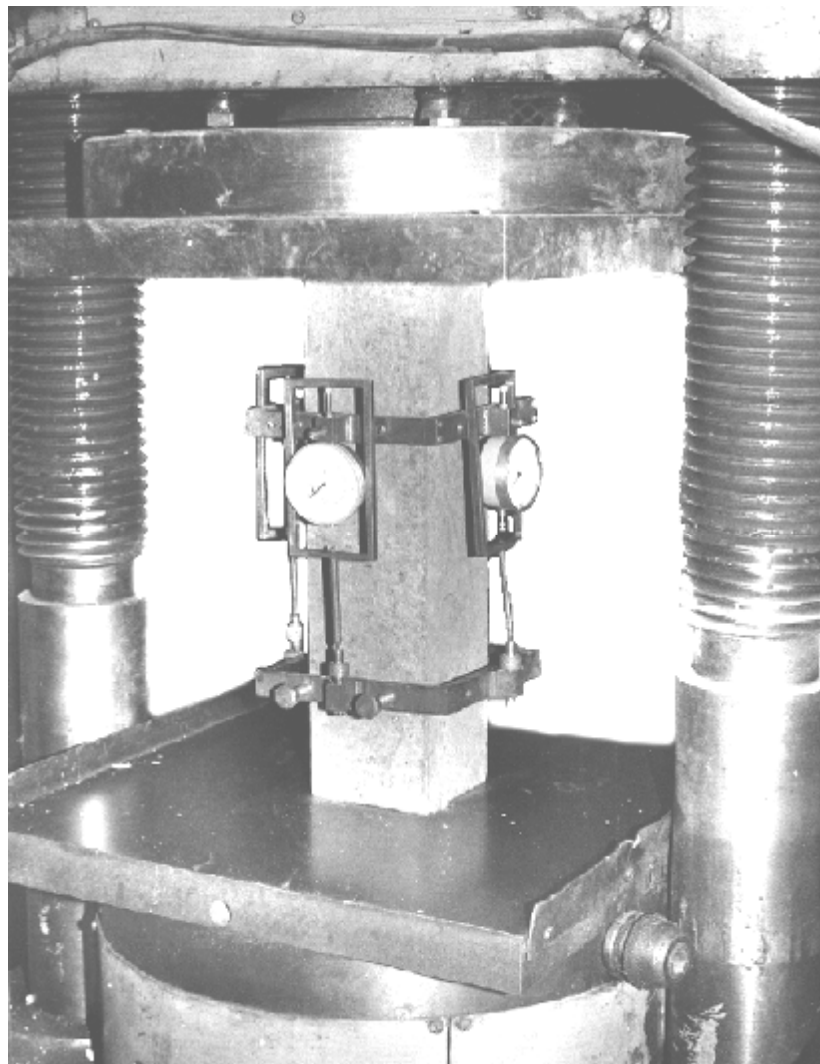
Фрагмент испытания бетонных призм.
